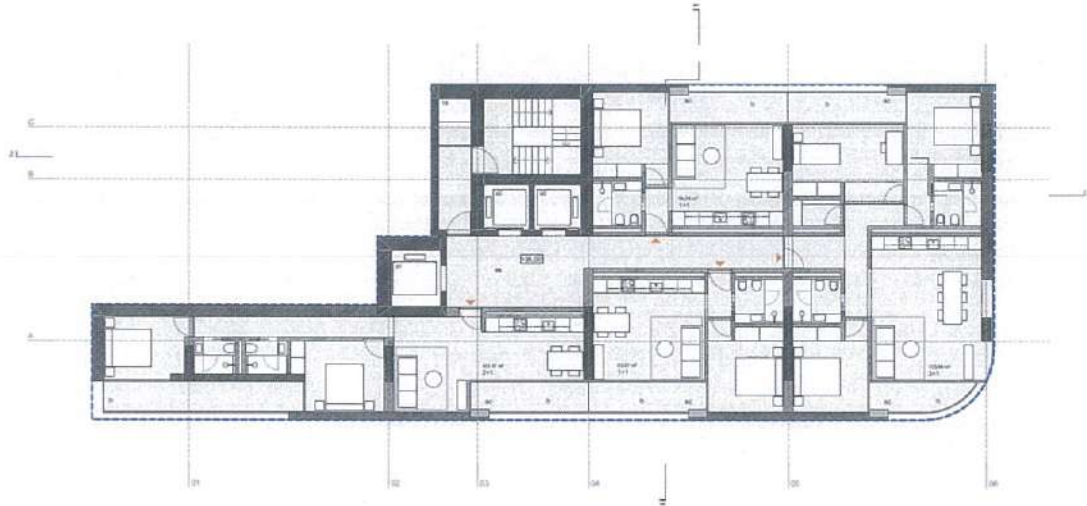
Planimetria e katit TIP te banimit per katet 7,19
